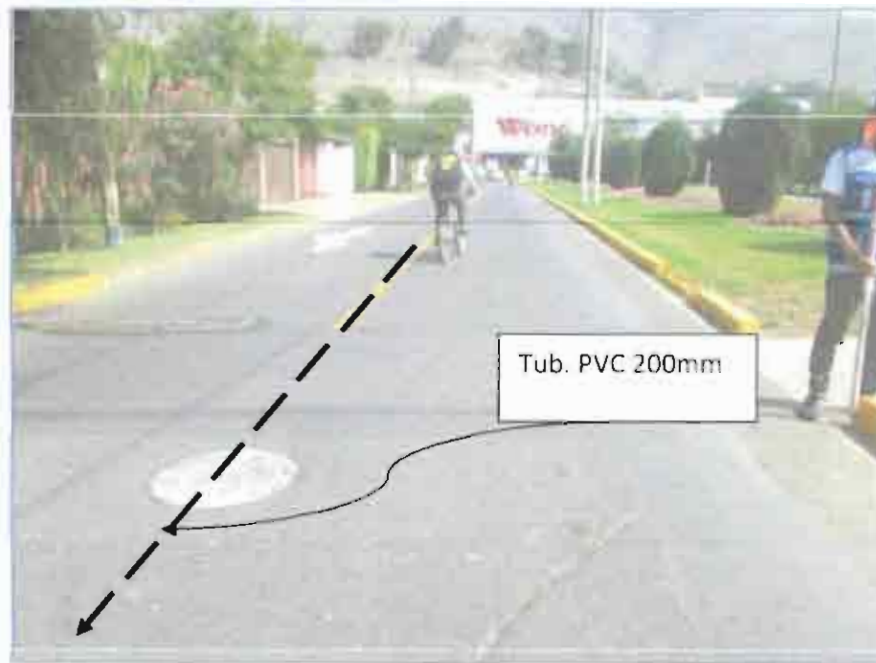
La red de alcantarillado proyectado en el Jr. el Velero, próximo a la Av. Elias Aparicio
